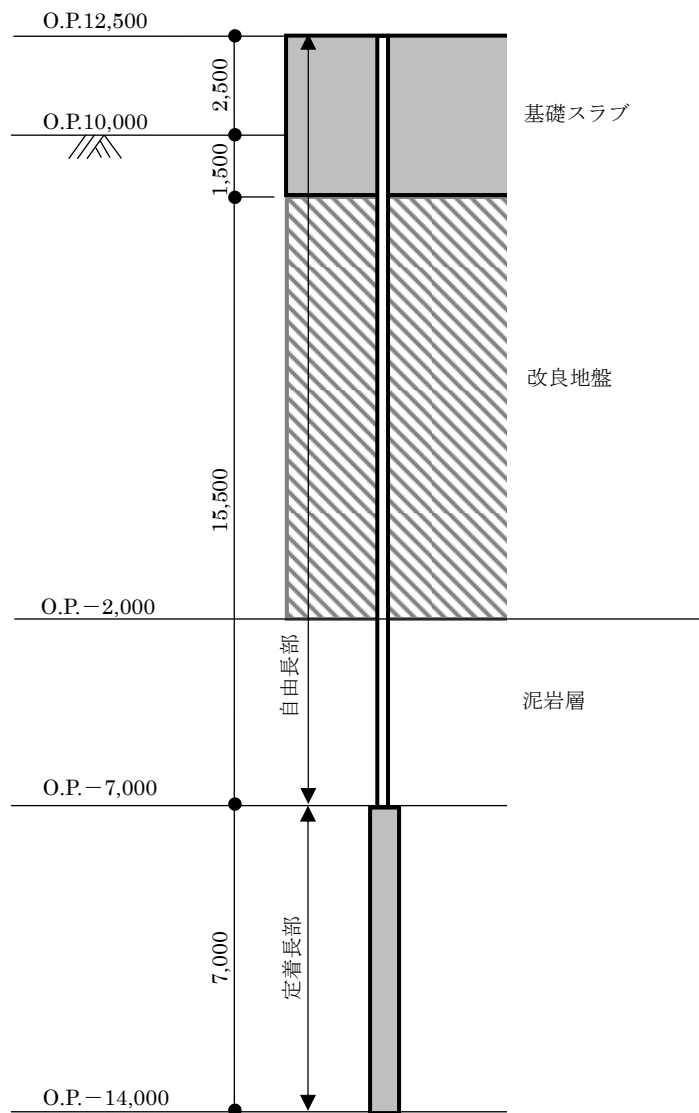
地盤アンカー設置計画 (単位：mm)
